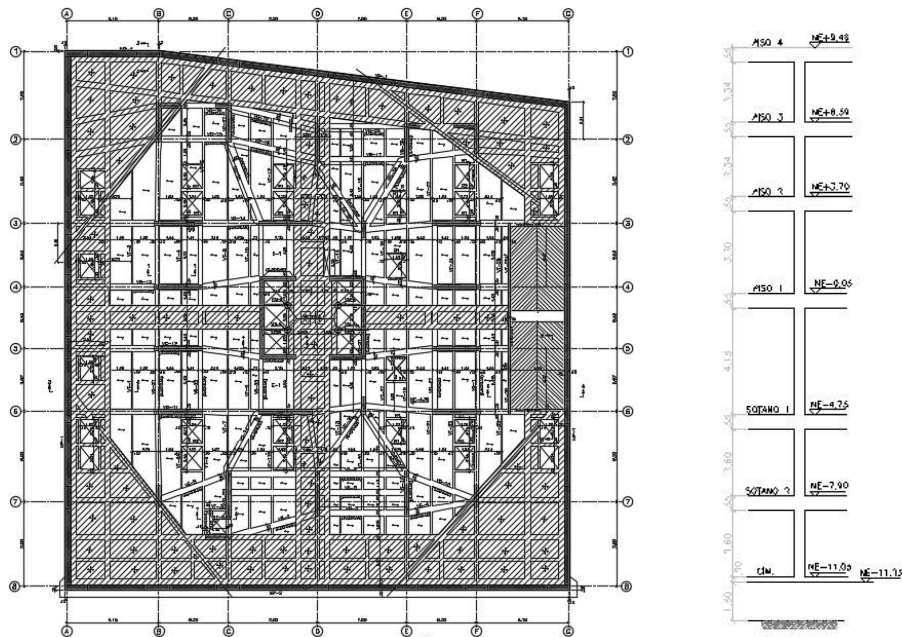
Planta y Esquema Vertical Sótanos del edificio Centum Business Building
